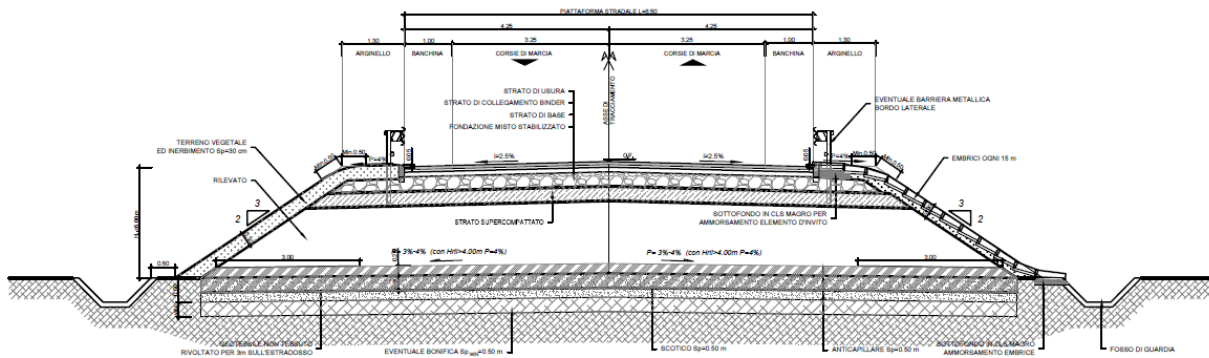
Sezione tipo rilevato – strada categoria F2 extraurbana
